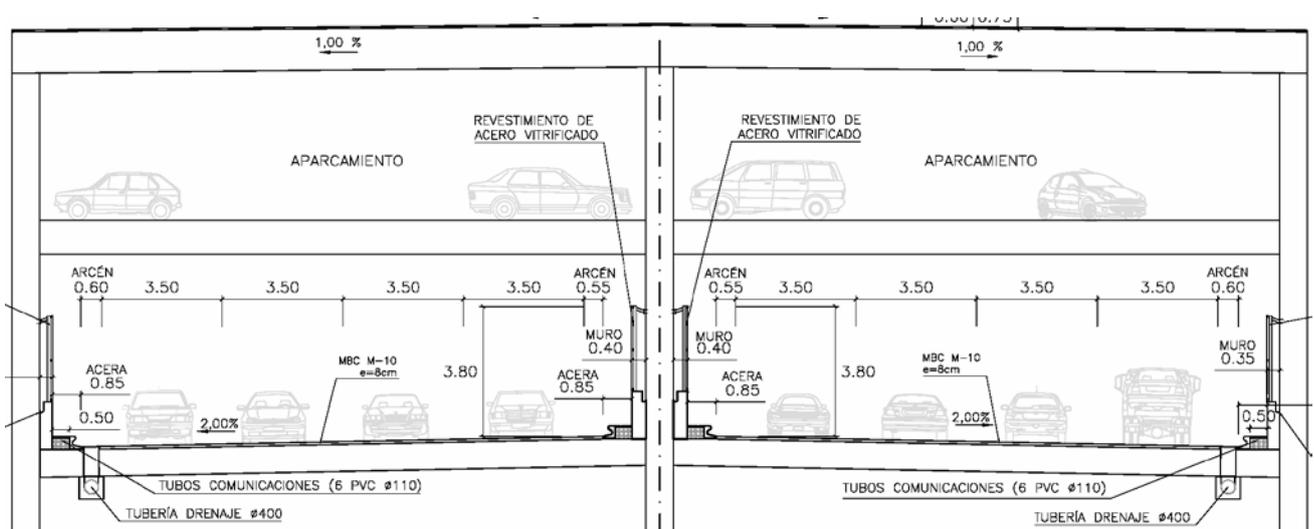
Túnel Avenida de Portugal. Sección transversal
